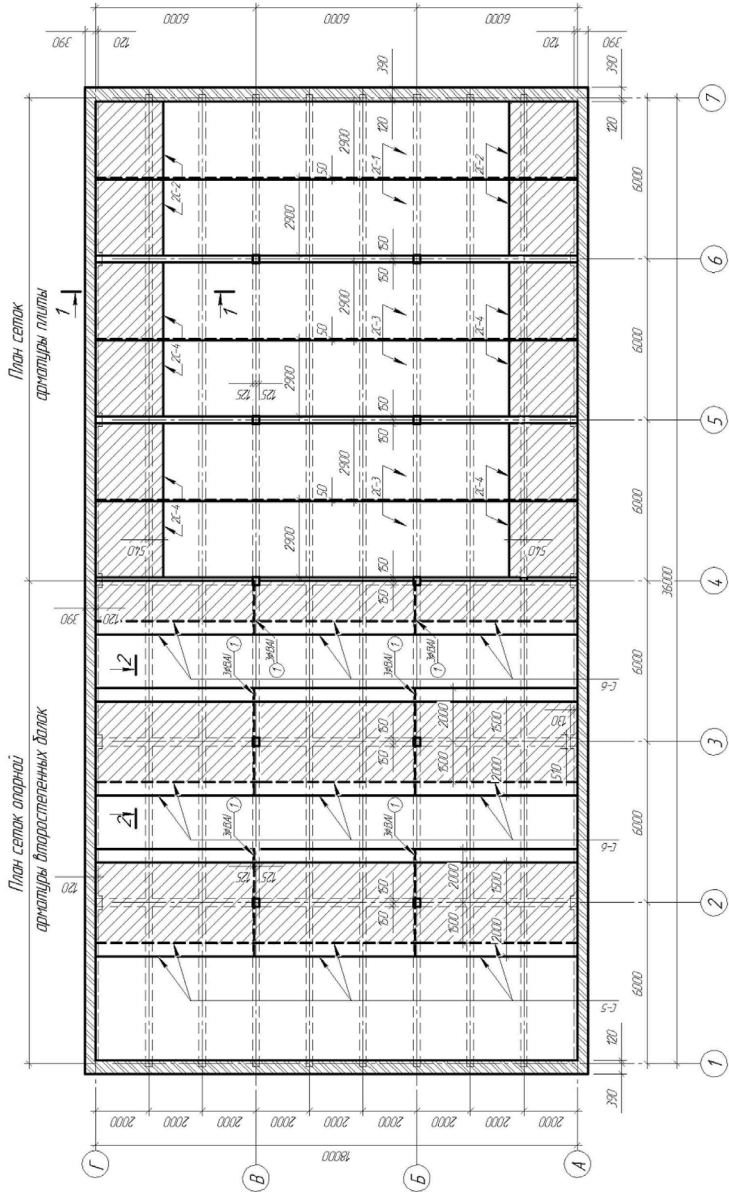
Раскладка сетки армирования плиты и опорных сеток второстепенной балки (штриховкой выделены двойные сетки)
